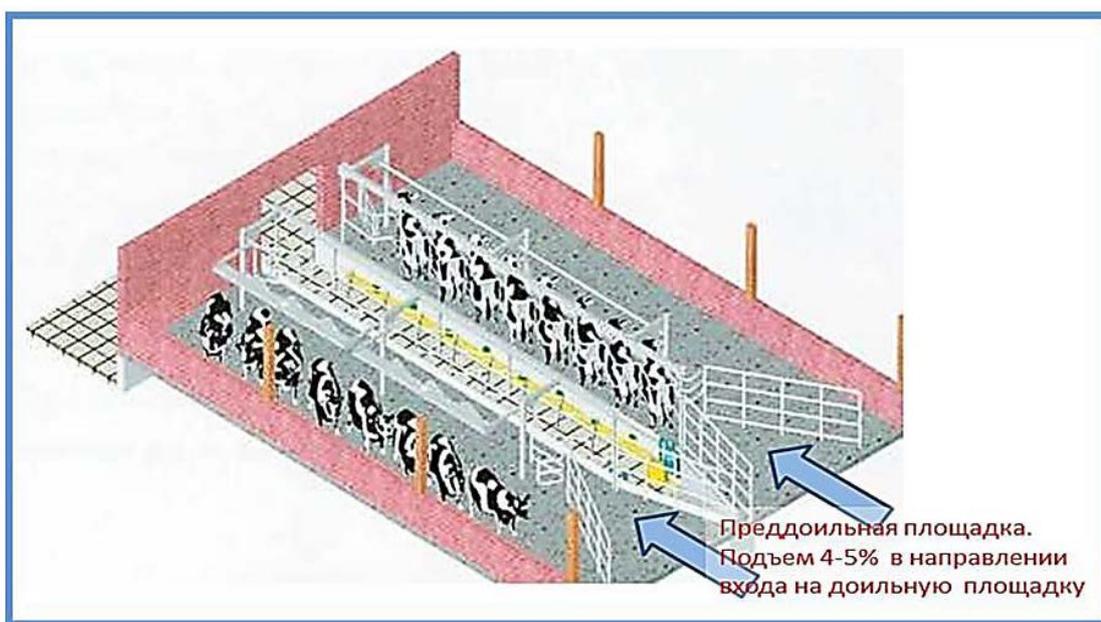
Схема планировки доильной площадки с уклоном
